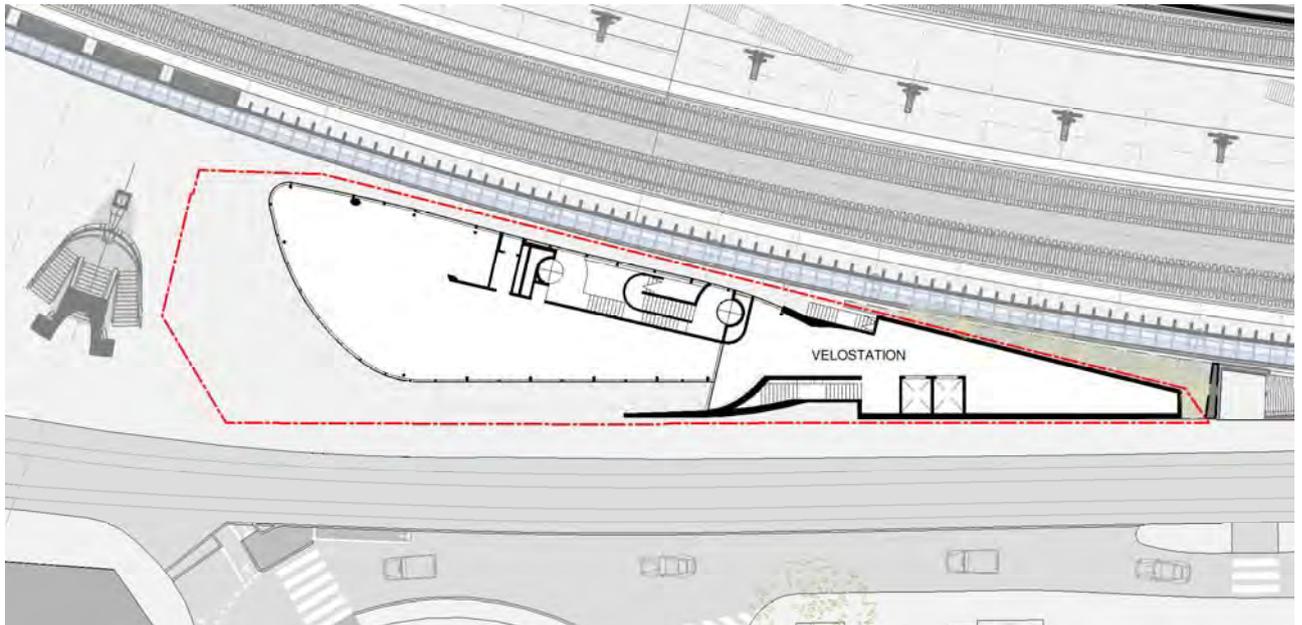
Grundriss Geschoss 0 mit Aussenbereich 1 im westlichen Teil des Grundstücks gemäss Richtprojekt „Haus zum Falken“ (Quelle: Calatrava Valls SA, Dezember 2015)
